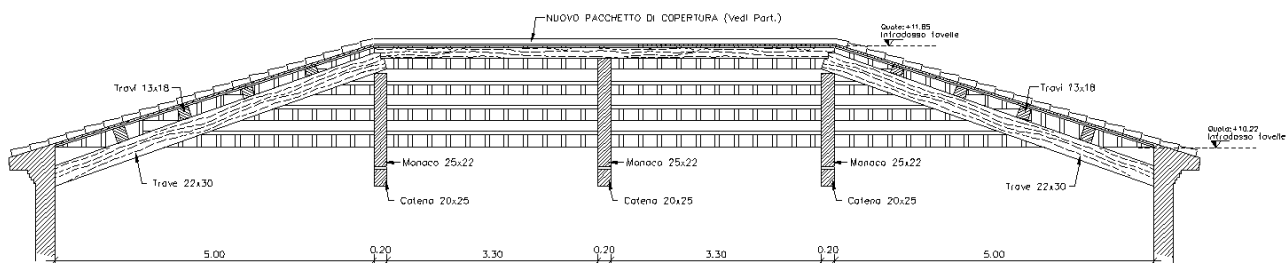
Ex-Lavanderie - stato di progetto: sez. B-B
